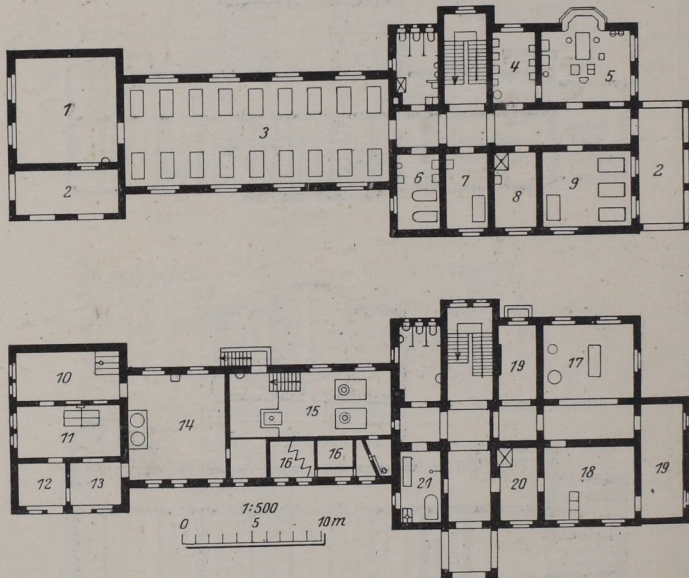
Petershofen O.-S. Knappschaftskrankenhaus, 80 Betten, Hauptgebäude, Ober- u. Erdgeschoß.
